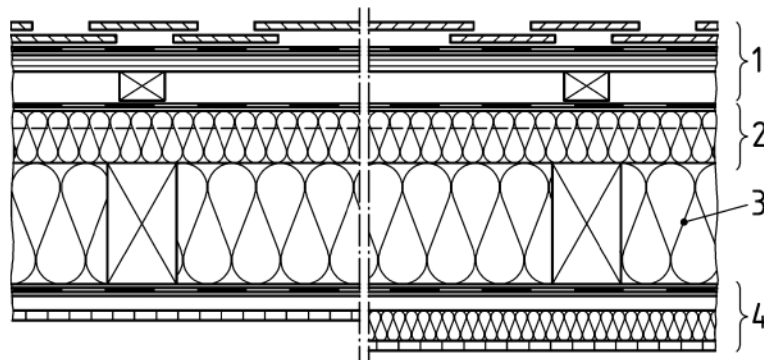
Konstruktionsbeispiel: nicht belüftete Dachkonstruktion mit belüfteter Dachdeckung, Zwischensparrendämmung, ggf. in Kombination mit geringfügiger Untersparrendämmung
